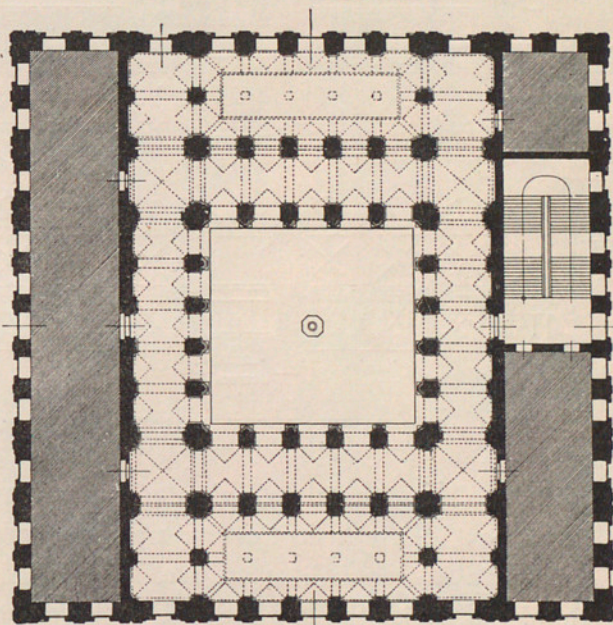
PLANTA DE LA LONJA DE SEVILLA.
